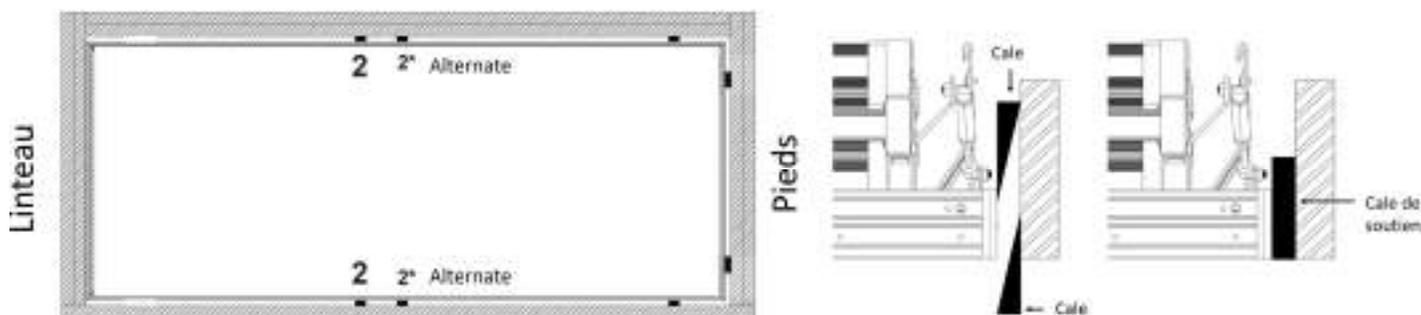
INSTALLATION DE CALES AU NIVEAU DU CADRE LATÉRAL
